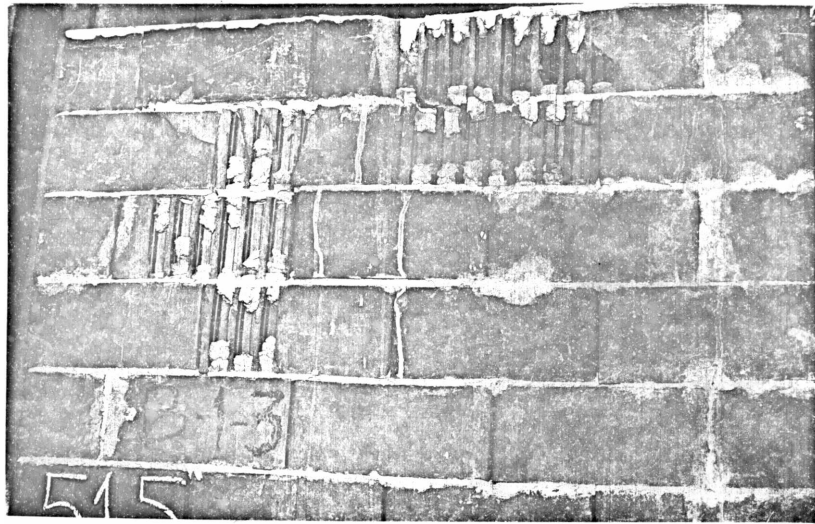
y 13.- Detalles de rotura, bloque tipo B-1
